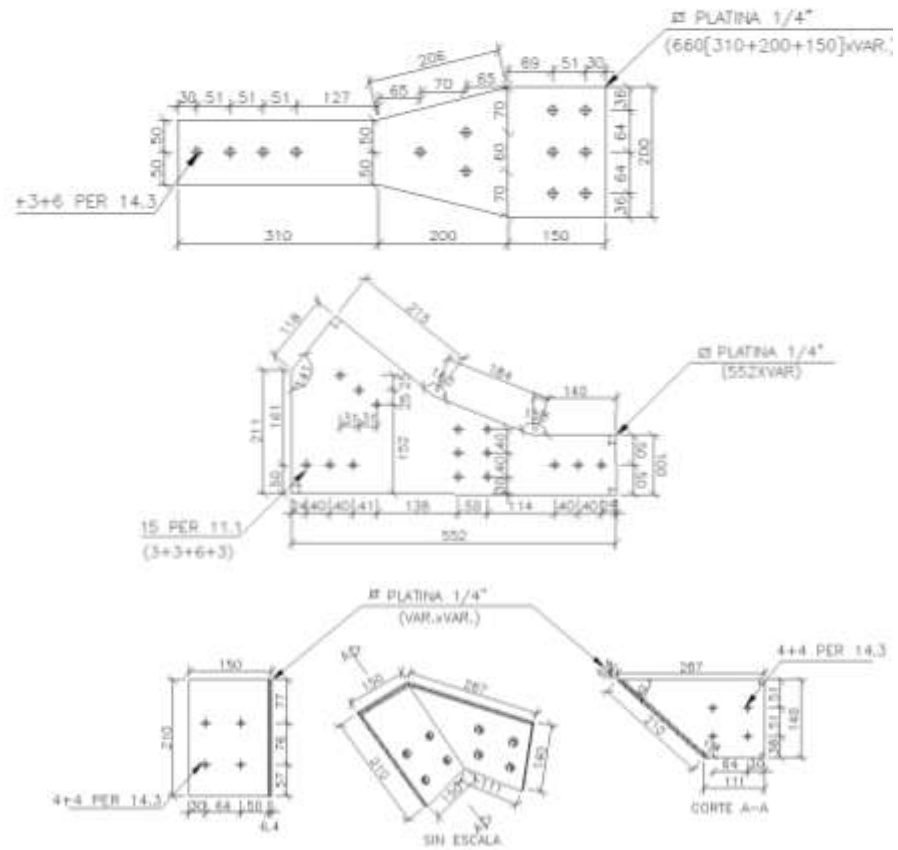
Detalles de fabricación platinas para conexiones P2-T1, C1-T8 y I-T7
